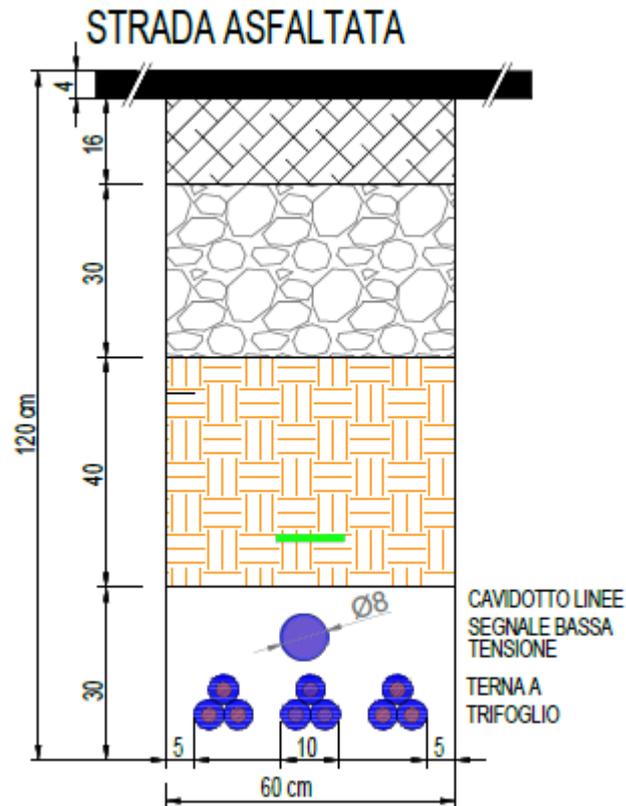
Sezione tipica di posa della linea in cavo su sede stradale per triplo cavidotto in MT
